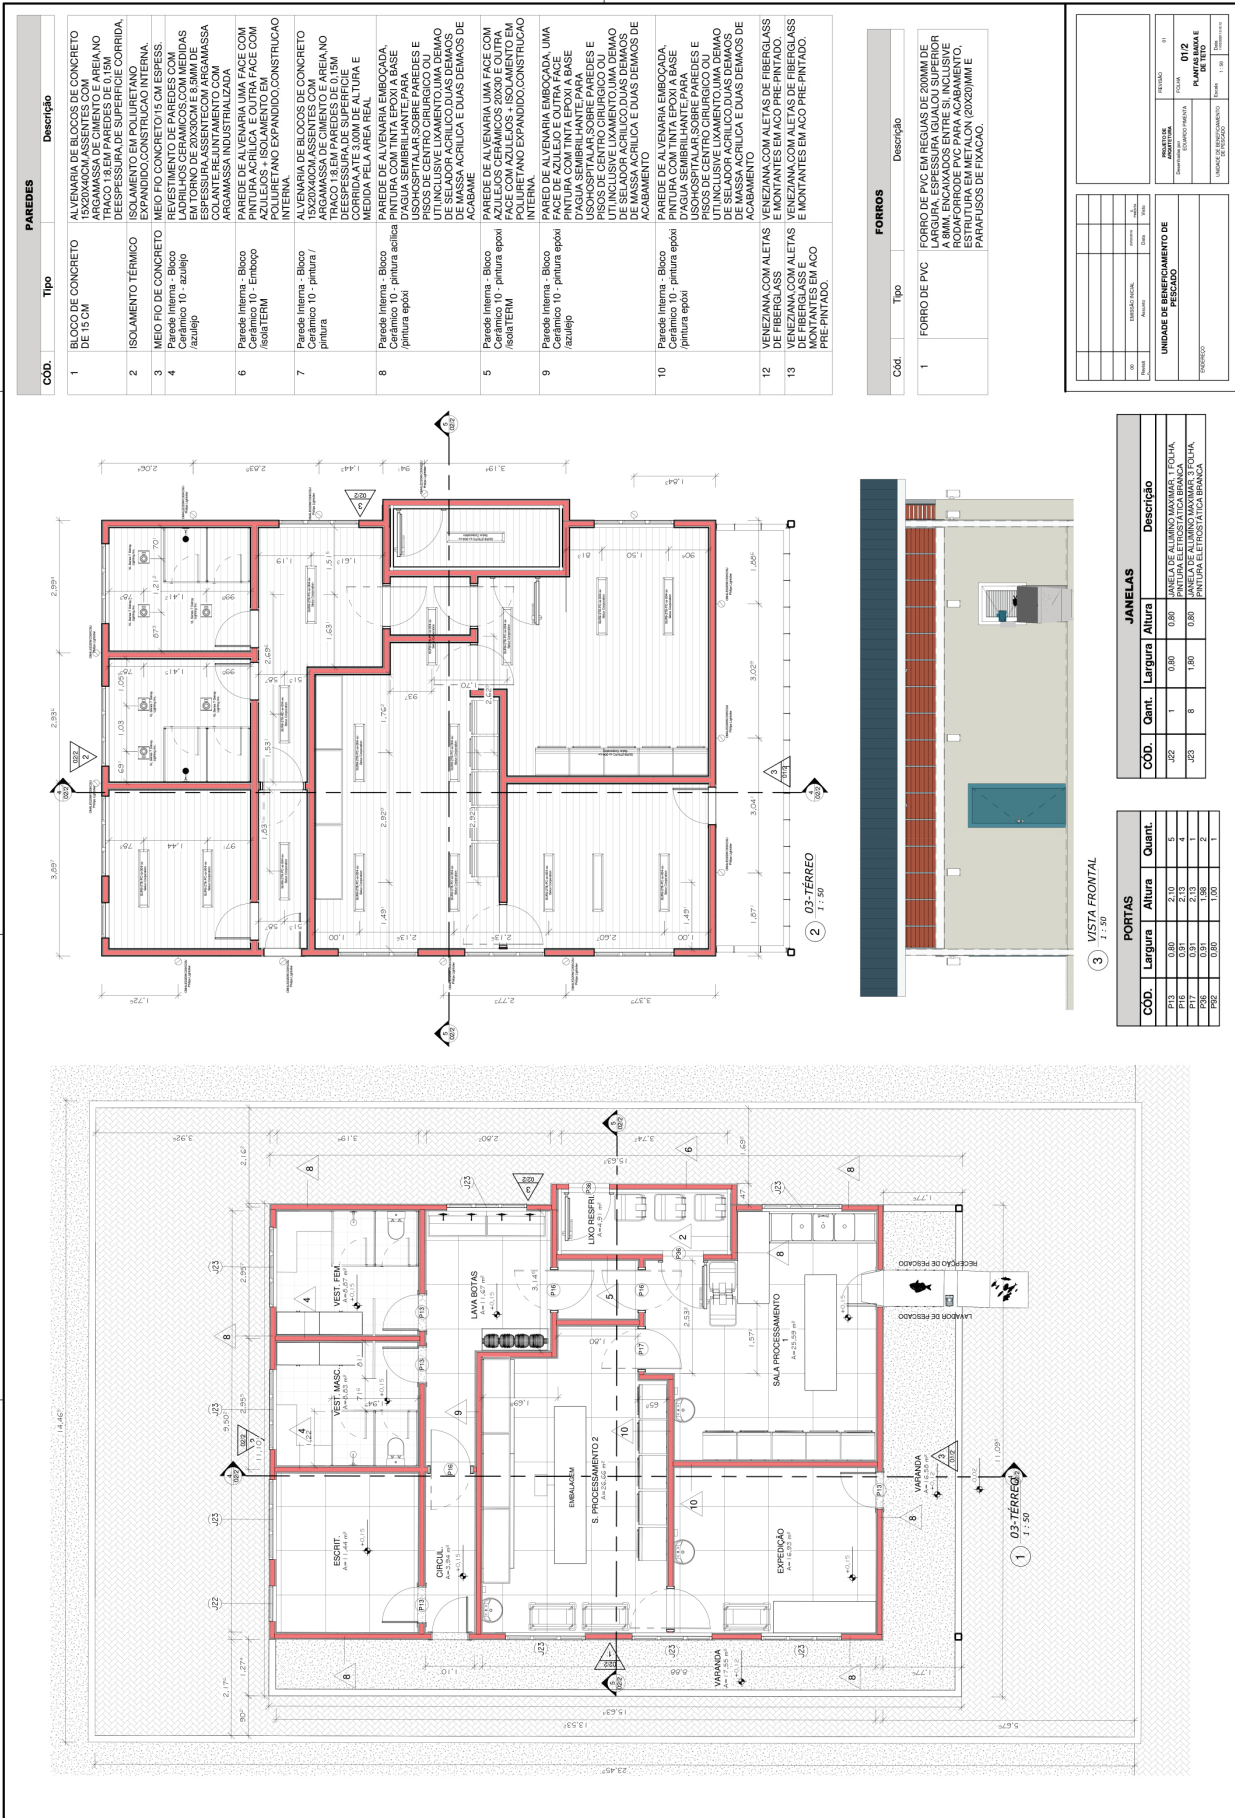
Projeto arquitetônico de uma unidade de beneficiamento de pescado (UBP). Planta baixa e delimitações estruturais. Ilustração: Carlos Eduardo Pimenta da Luz.
